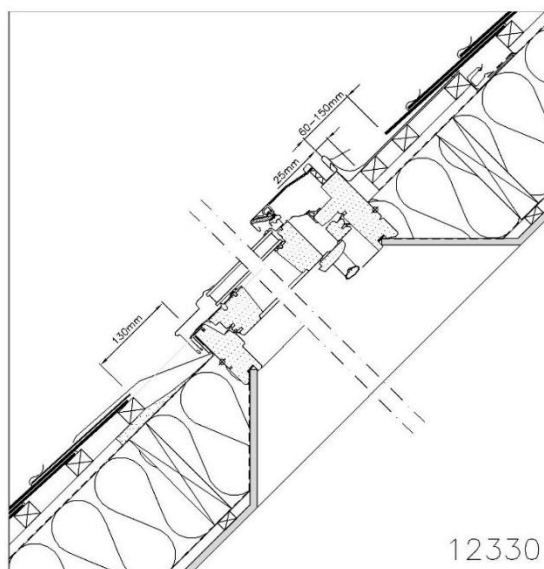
Pose d'une fenêtre de toiture sur des ardoises à recouvrement double
